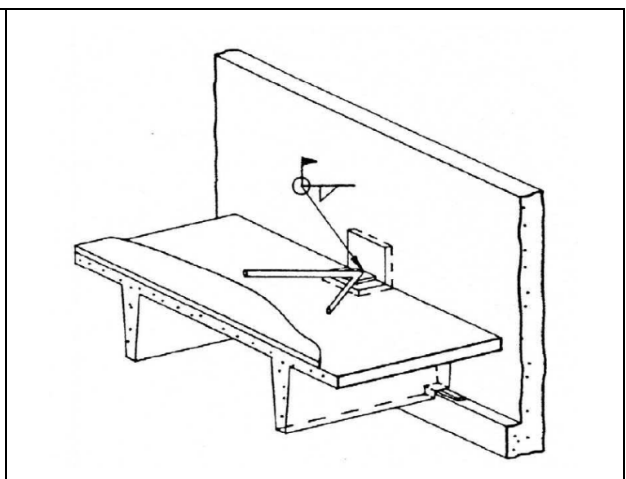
Ligação de lajes duplo “T” em vigas “L”, com chapas soldadas, assentes em neoprene, perpendiculares à laje de piso (PCI)
